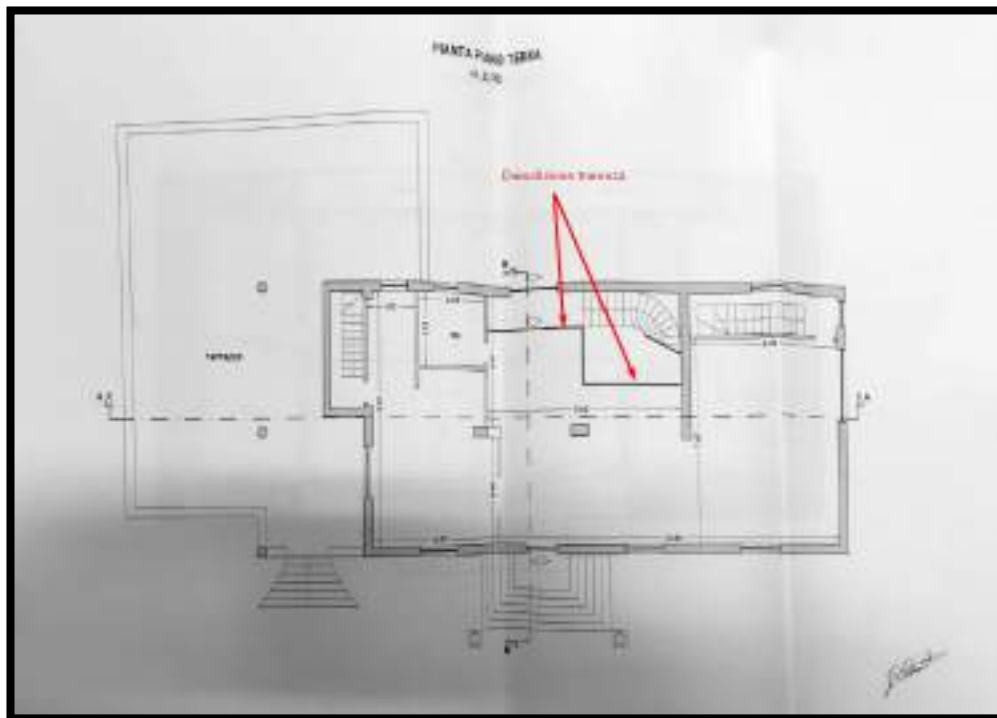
Pianta piano terra allegata alle pratiche di condono
